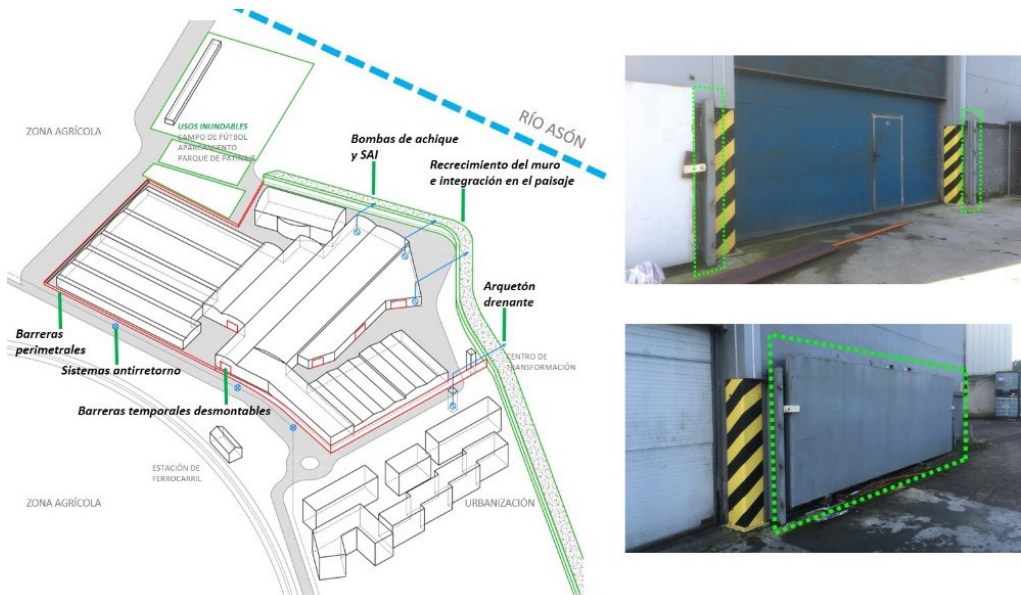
Caso piloto en Ampuero: esquema resumen de la propuesta. Detalle: barreras temporales desmontable.
